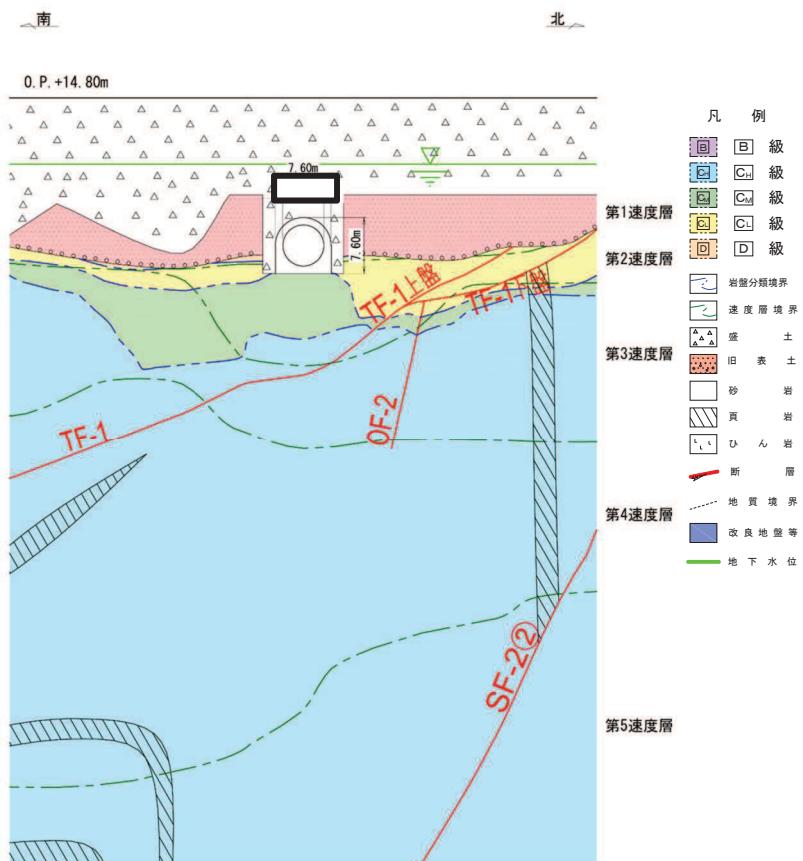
排気筒連絡ダクト（土砂部）評価対象断面図（断面③）
